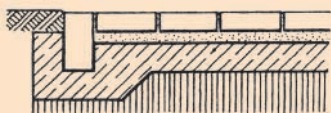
A haces con la superficie pavimentada. La pendiente va con el borde del pavimento.
